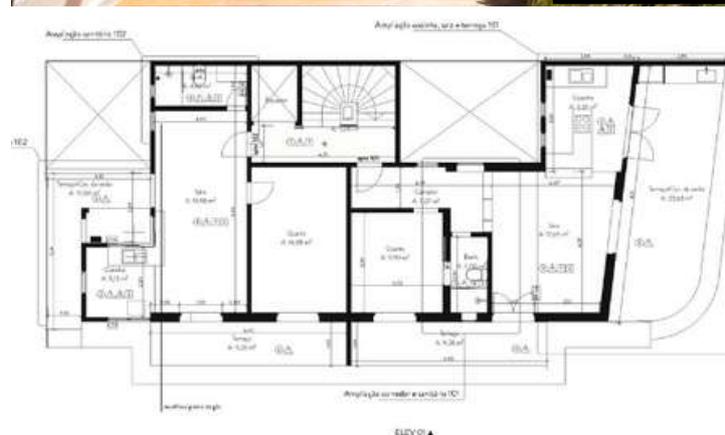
Planta baixa do 1º Pavimento Recuado.
